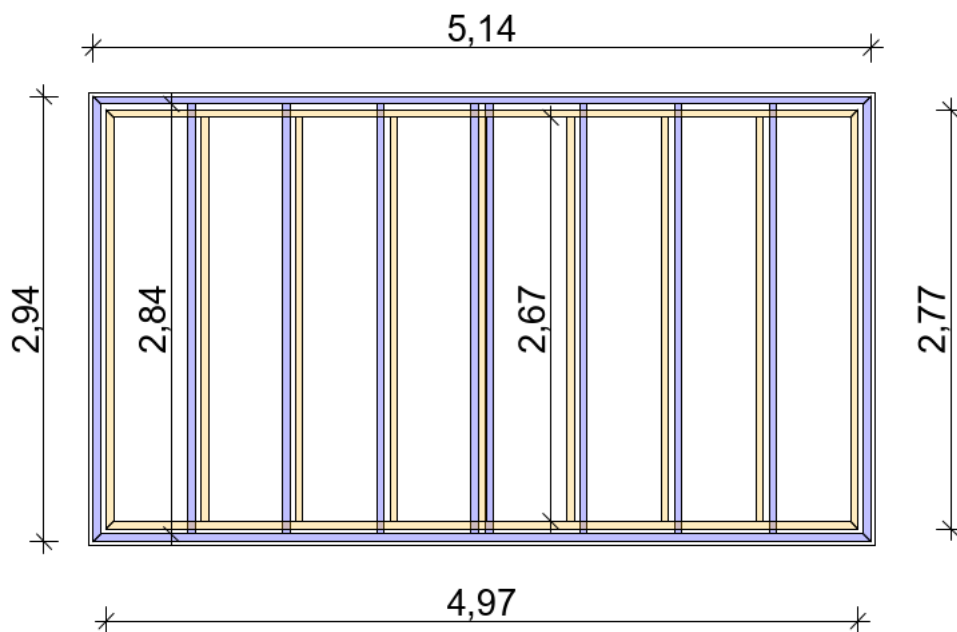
U-Profile (Blau=Äußere Lage, Orange=Innere Lage)
